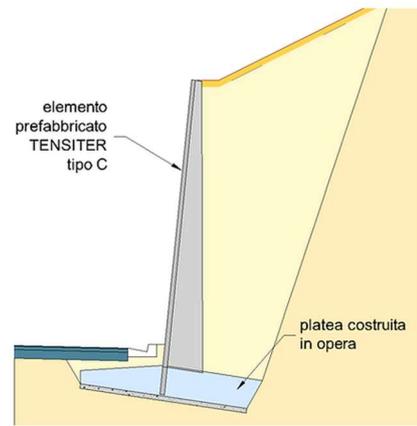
Muros Tensiter Tipo C (Fuente: [18])
